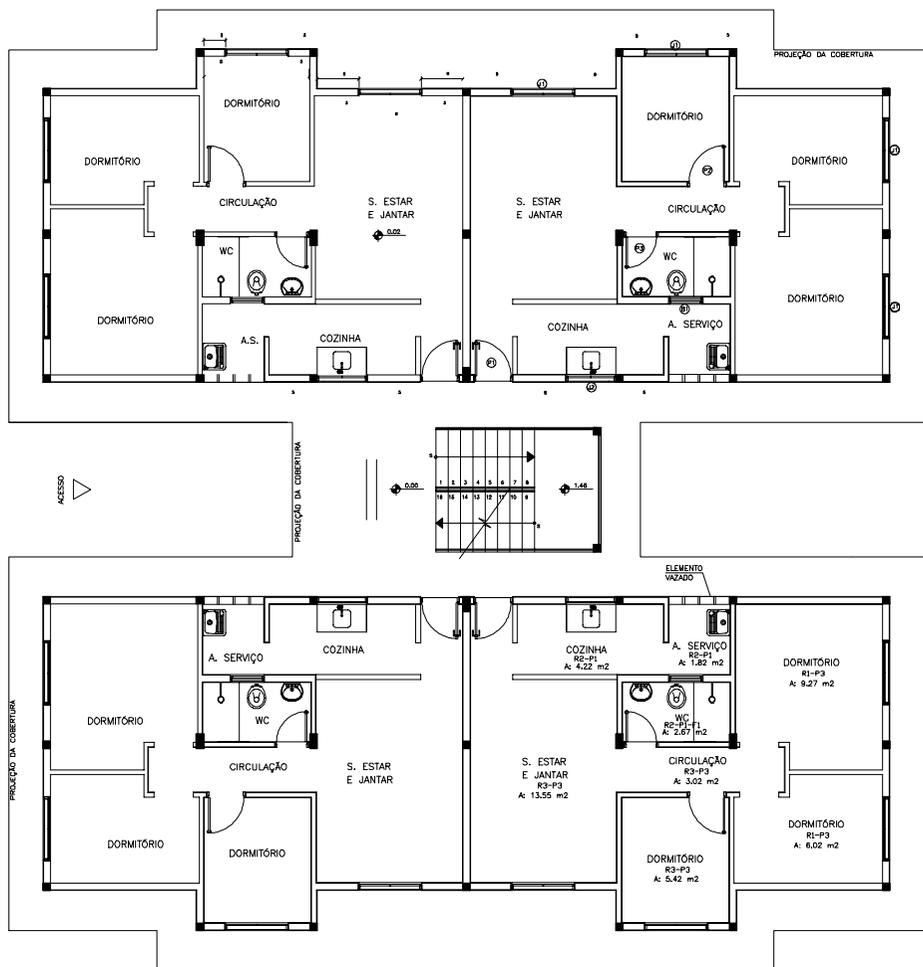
Planta baixa do pavimento tipo na segunda versão do projeto (sem escala). Fonte: PMB, 2004.
